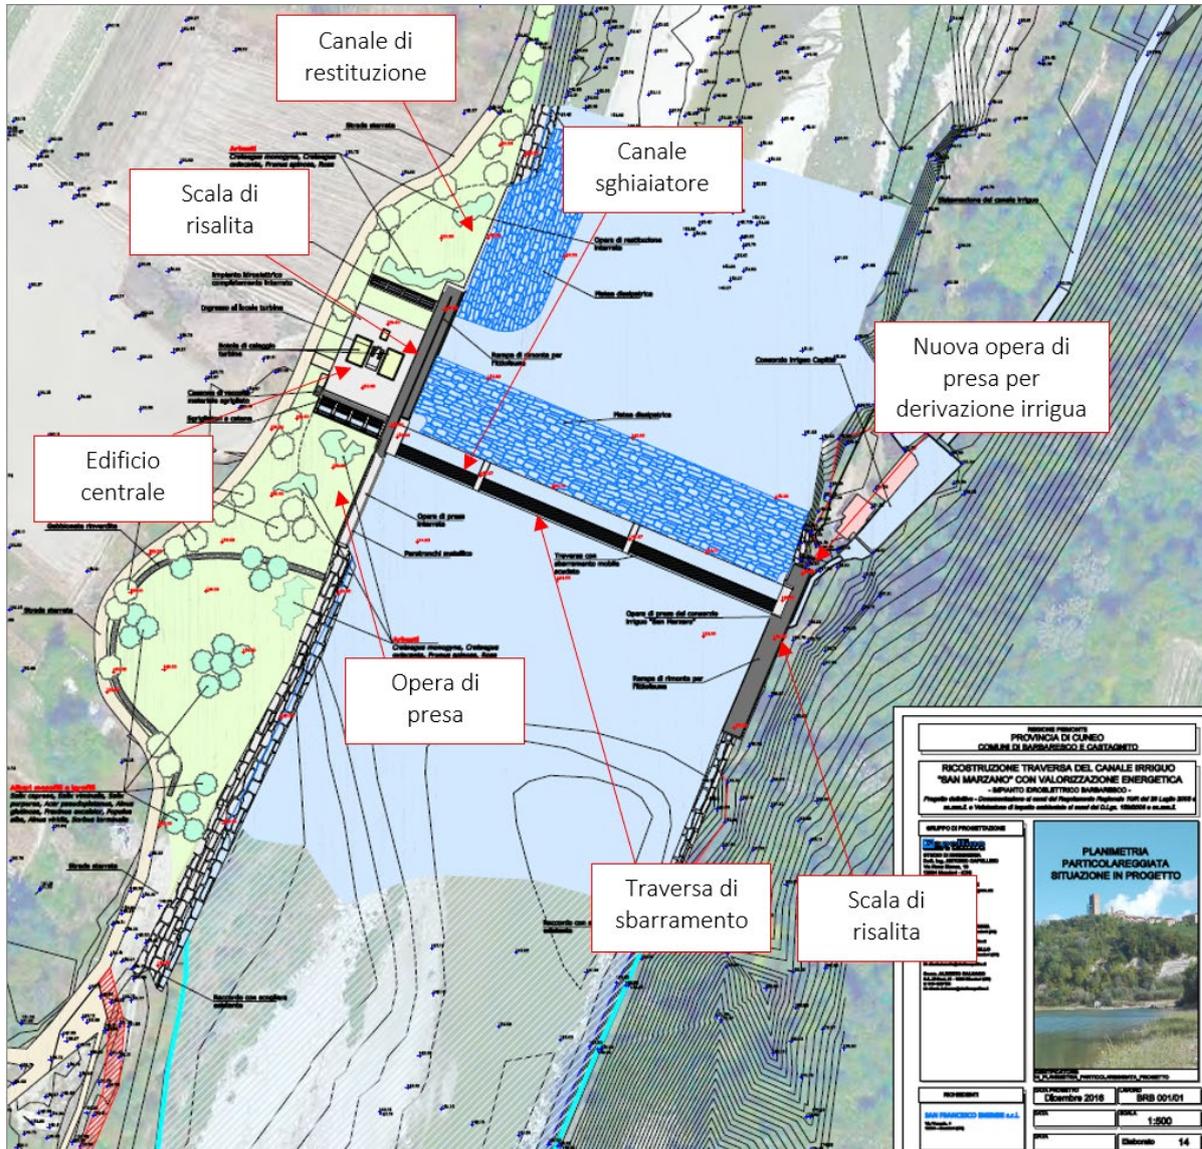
Estratto dell'Elab. 14 – Planimetria particolareggiata situazione in progetto (dicembre 2016)
